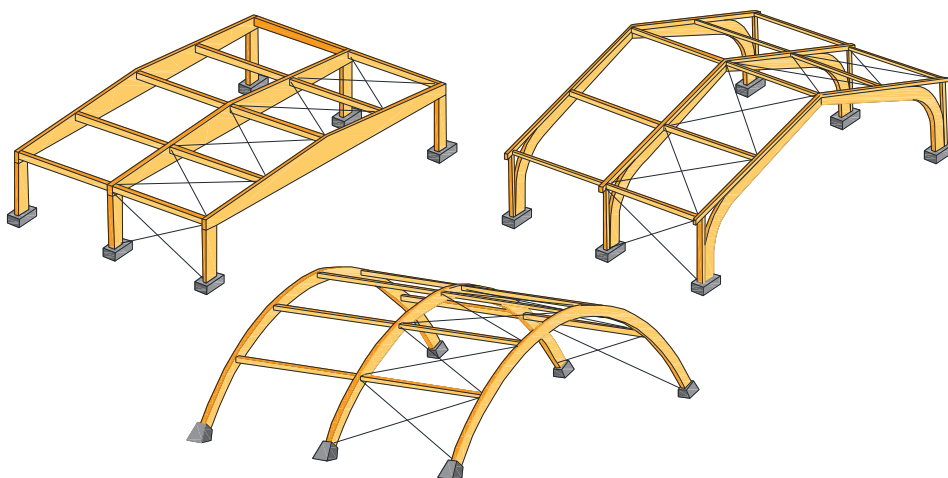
Pórticos e arcos a constituírem estruturas mais complexas [Adaptado (Borgström, 2016)].
